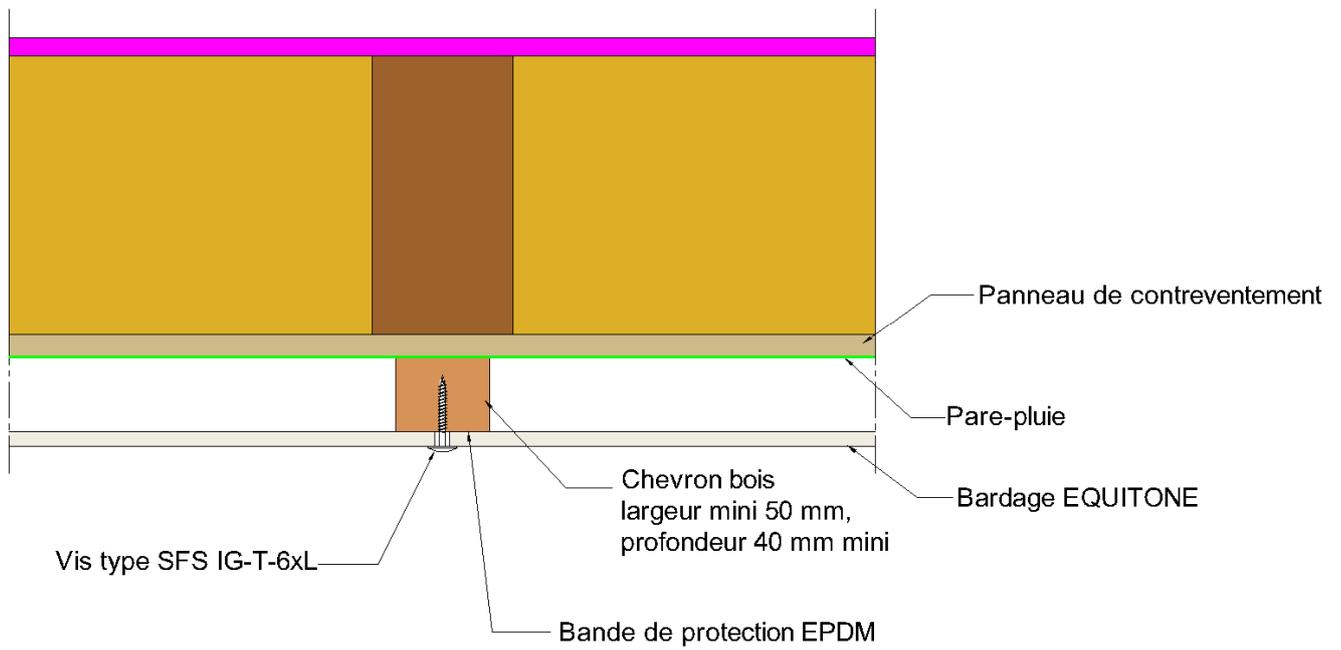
Ossature croisée - Coupe horizontale - Pose sur COB
